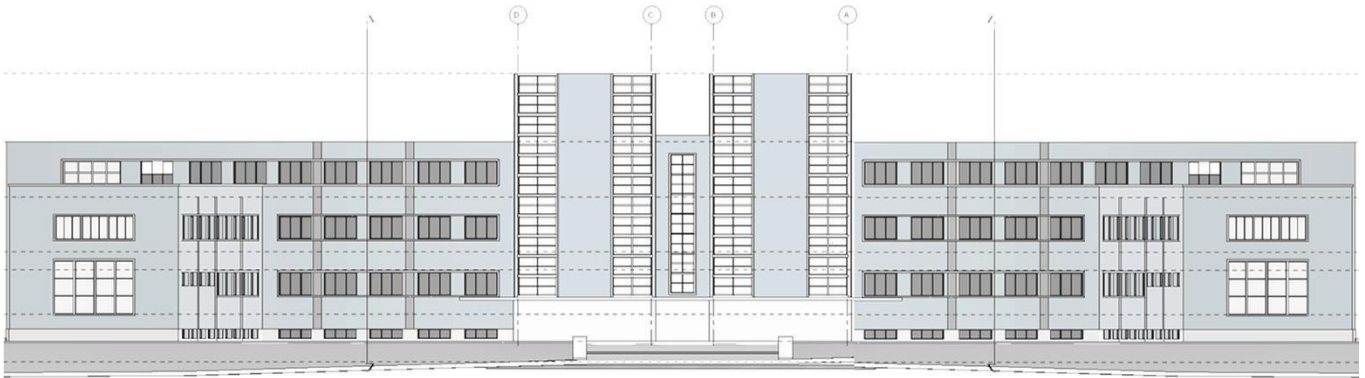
L'Istituto di Botanica. Building Information Modeling, vista del prospetto di ingresso.
